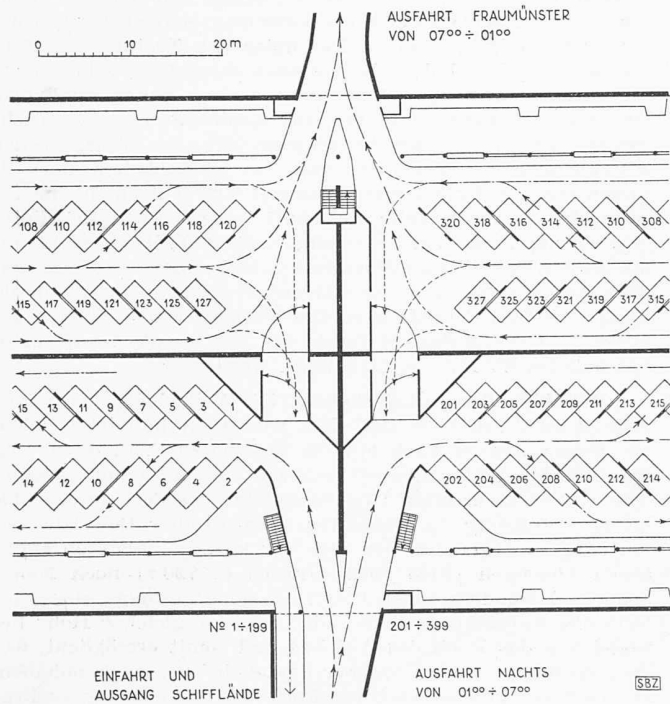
Einzelheiten, Grundriss 1:800
